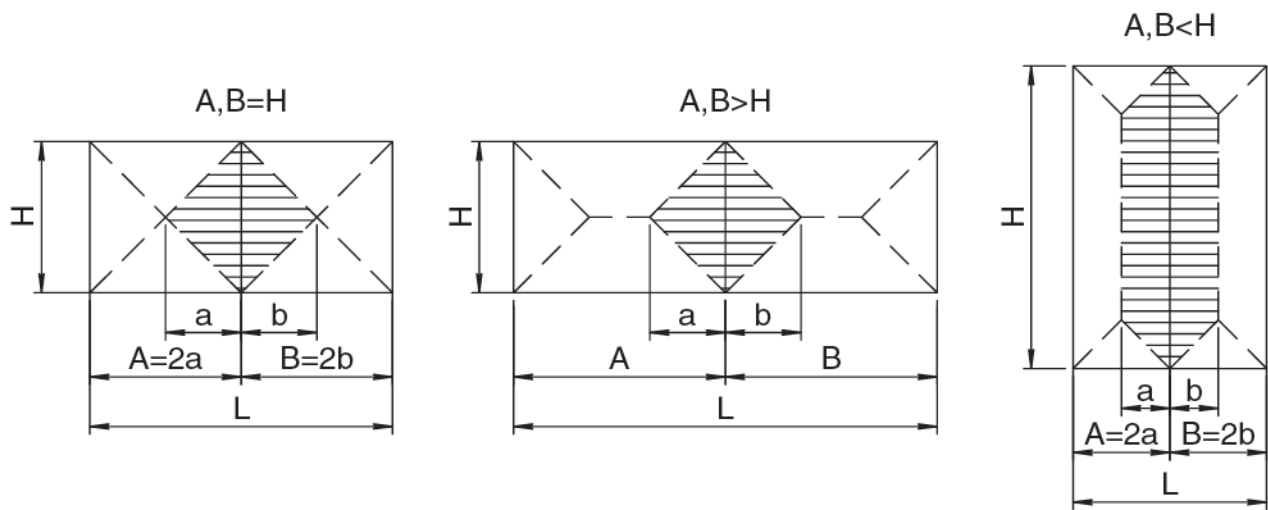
Расчетная схема ветровой нагрузки W_m
